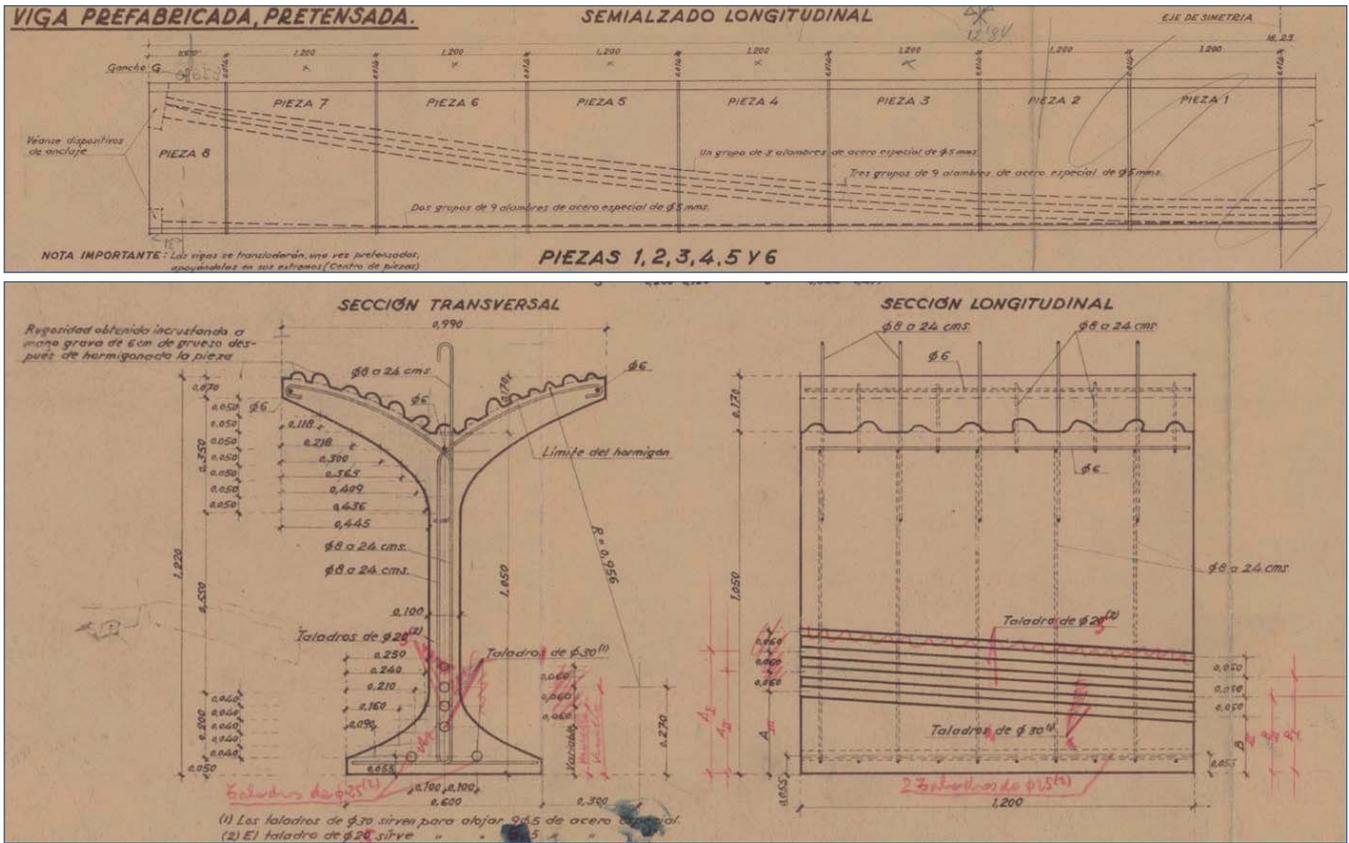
Configuración del pretensado longitudinal y detalle de la sección transversal de las vigas
